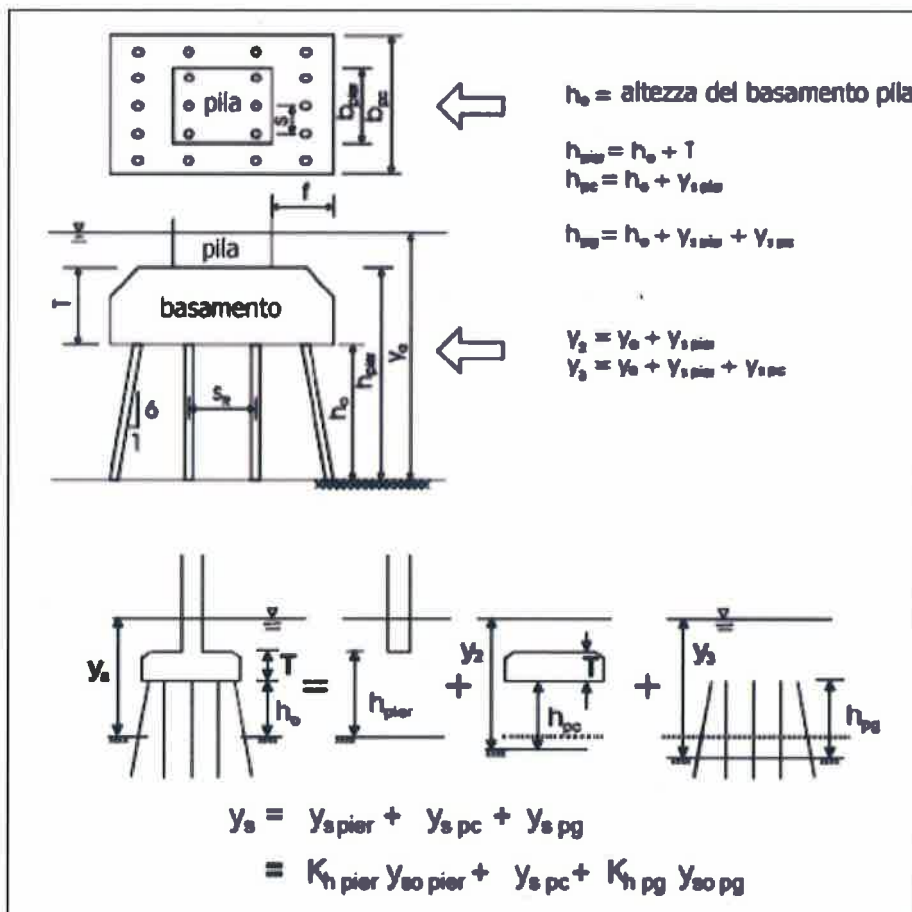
Principio di sovrapposizione degli effetti per pile composite o fondazioni esposte alla corrente, tratto da “Scour Around Exposed Pile Foundations”, Salim, M. and J. Sterling Johnes ASCE Water Resources Engineering Conference, 1999
